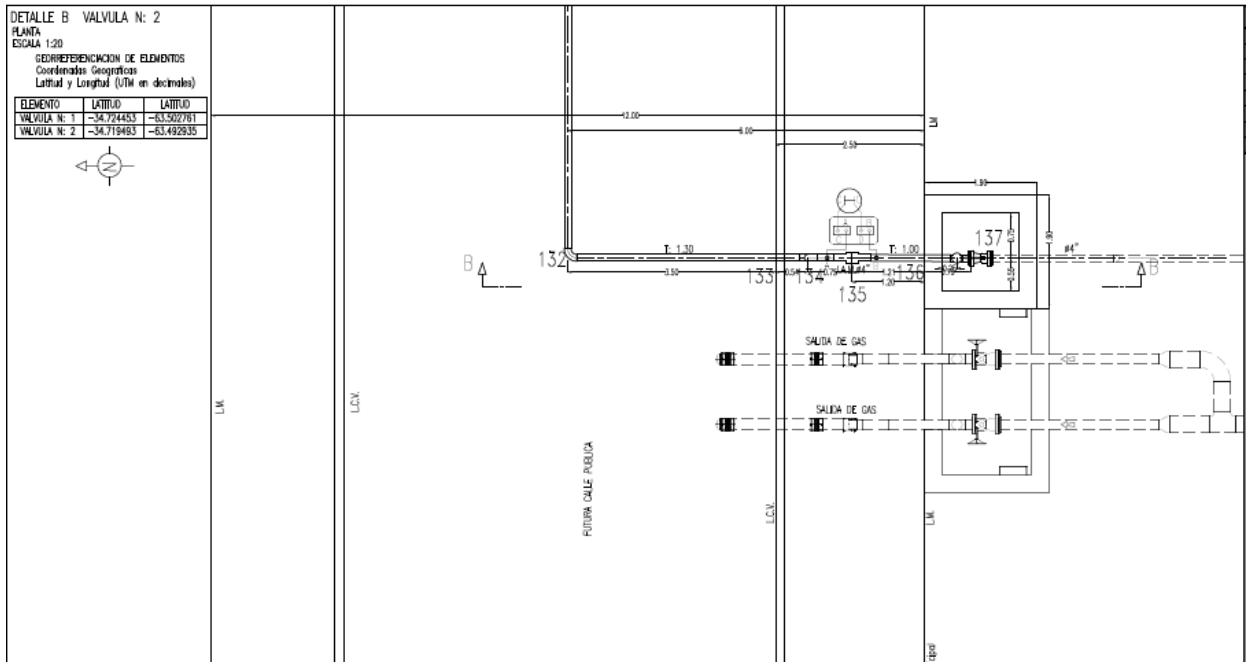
Detalle: ramal de alimentación - PRF a instalar.
